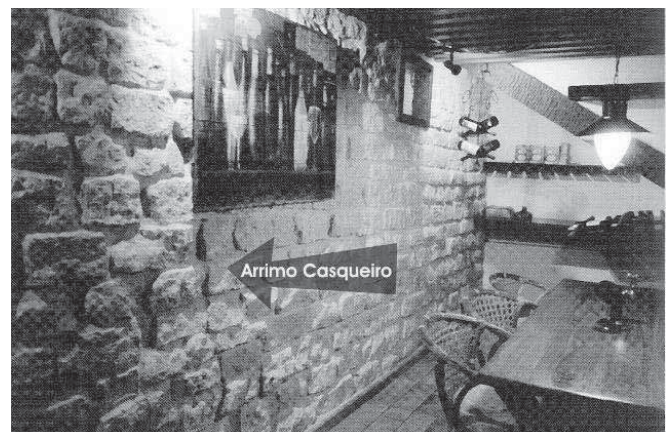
Adega. Arrimo com blocos de casqueiro. Obra R. Azevedo. Capa e matéria da Revista Pedras do Brasil. 2002 (foto do César Romero).
